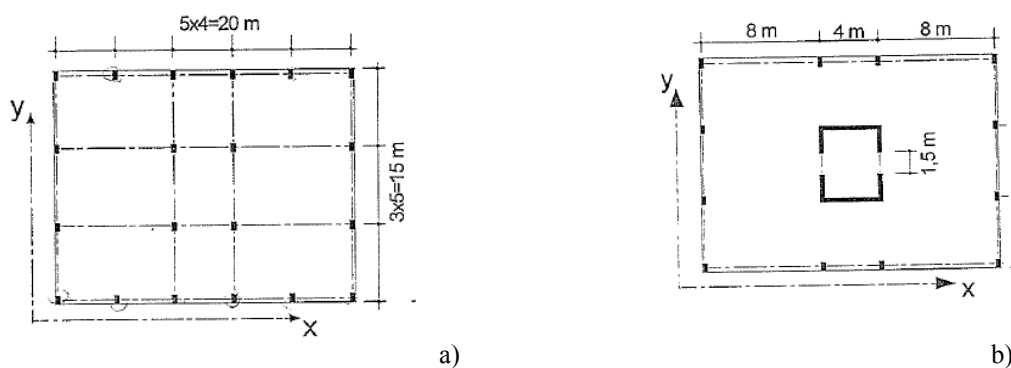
Desenvolvimento em planta da configuração 1, 2 3 e 6 (a) e da configuração 5 (b).
